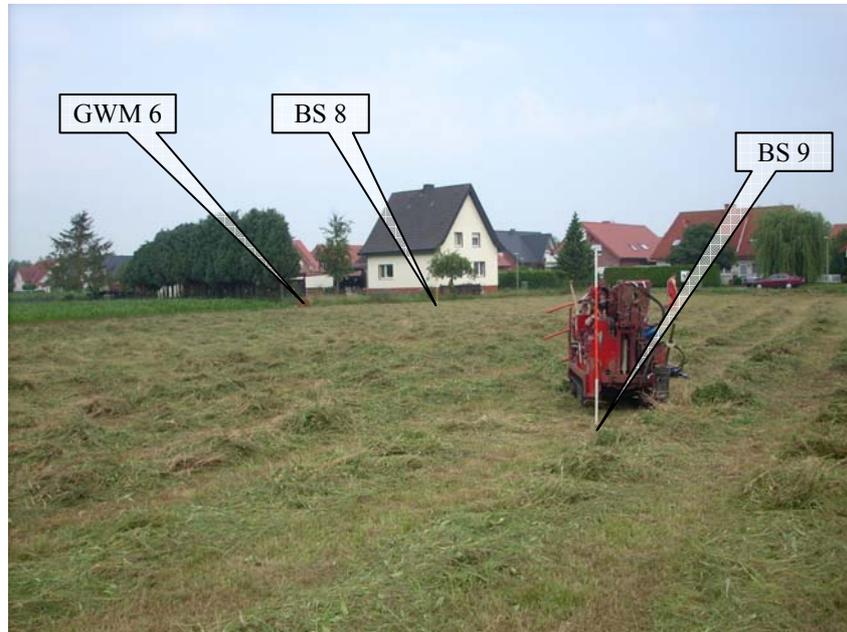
Blickrichtung ~ NW; Bereiche der BS 6 (Markierung); ausgebaut zur Grundwassermessstelle GWM 6, der BS 8 (Markierung) und der BS 9 (Markierung)
